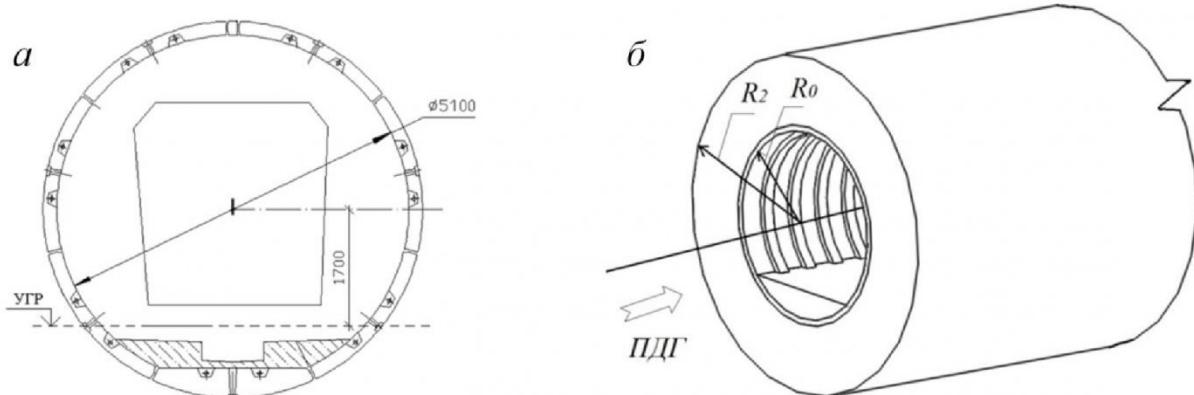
Однопутный тоннель с железобетонными тюбингами: а – чертеж; б – схема к расчетной модели
